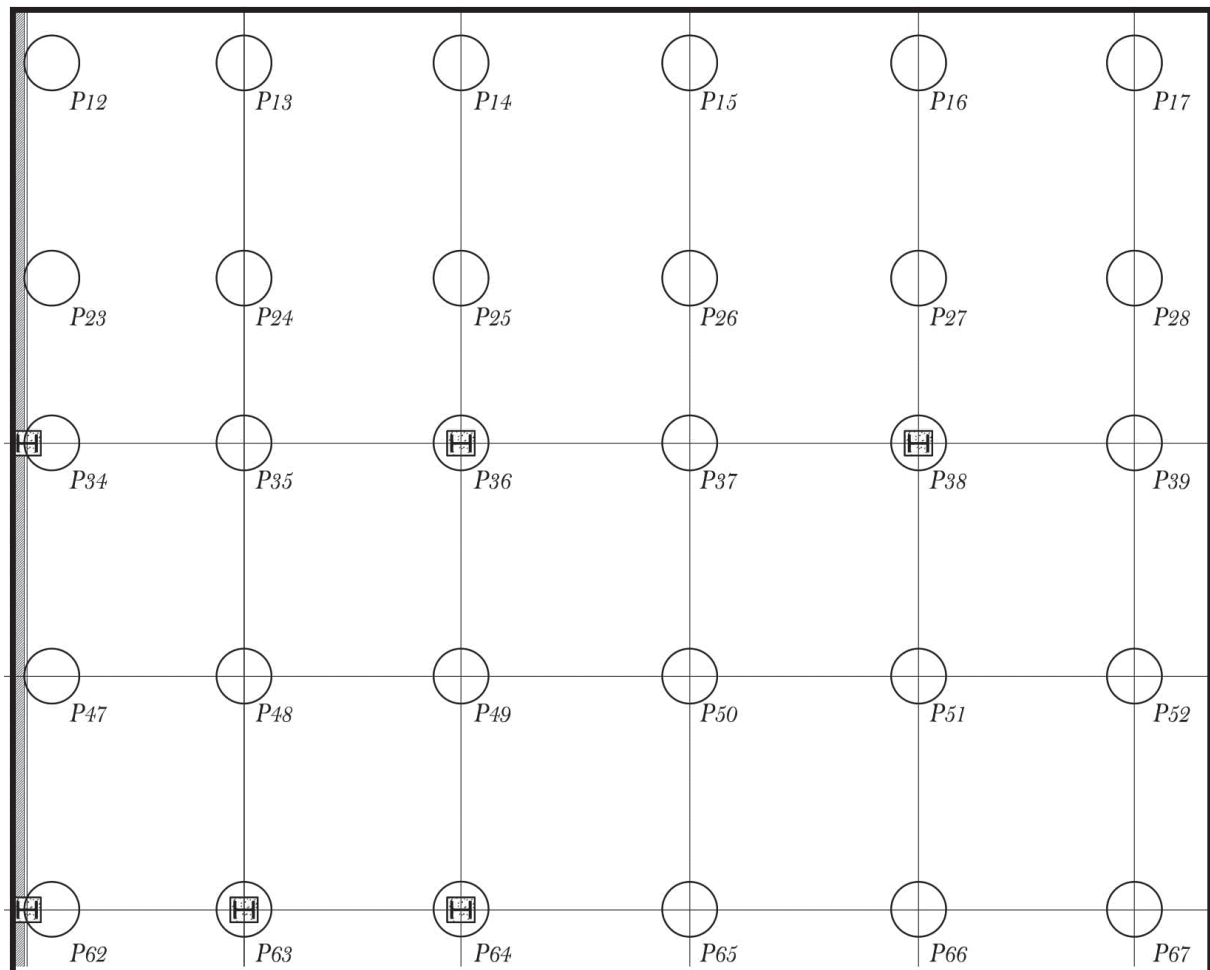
pieu Ø100 en coffrage et en ferrailage.
